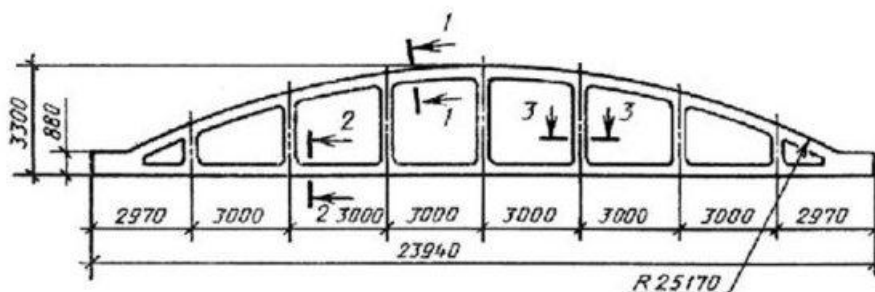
Геометрія безрозкісної ферми покриття
